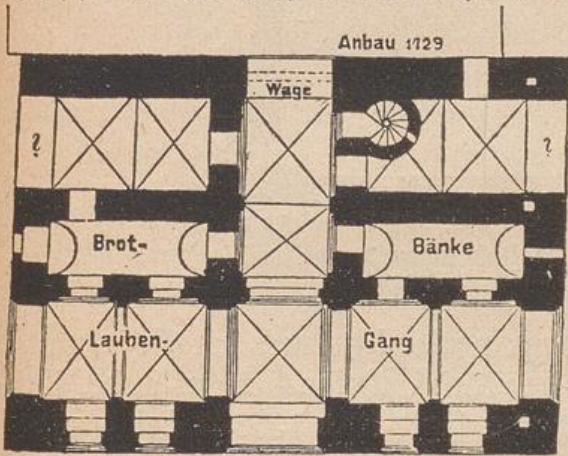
Rathaus zu Marienburg in Westpreußen. Grundriß des Erdgeschosses.
